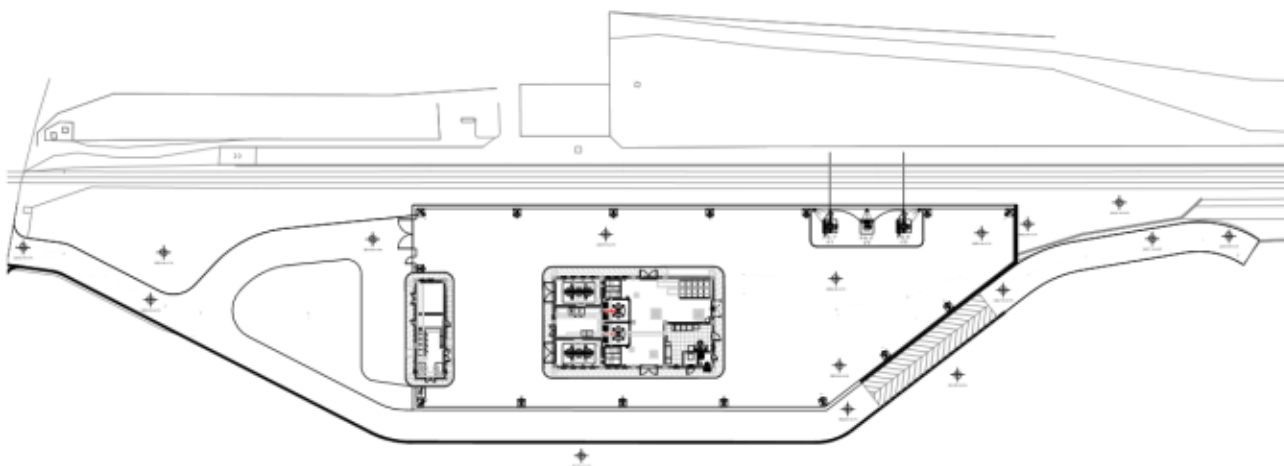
SOTTOSTAZIONE ELETTRICA - PIAZZALE – UBICAZIONE IMPIANTO
